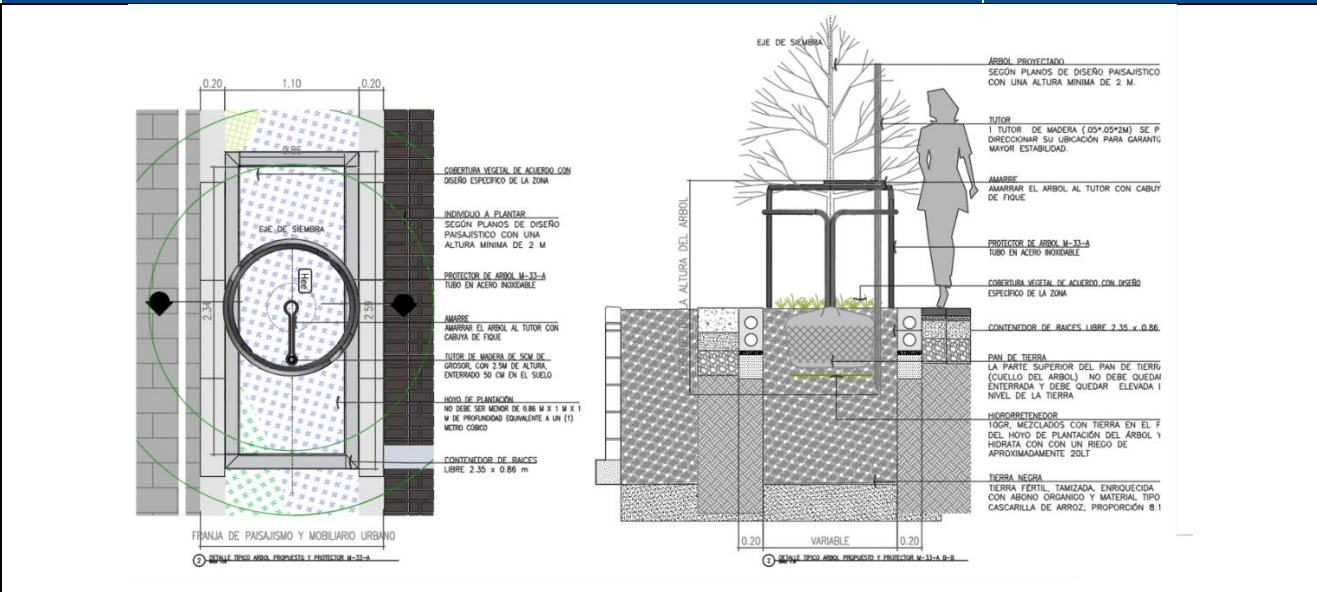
Planta detalle del Contenedor – Alcorque (0.86cm x 2.35)
